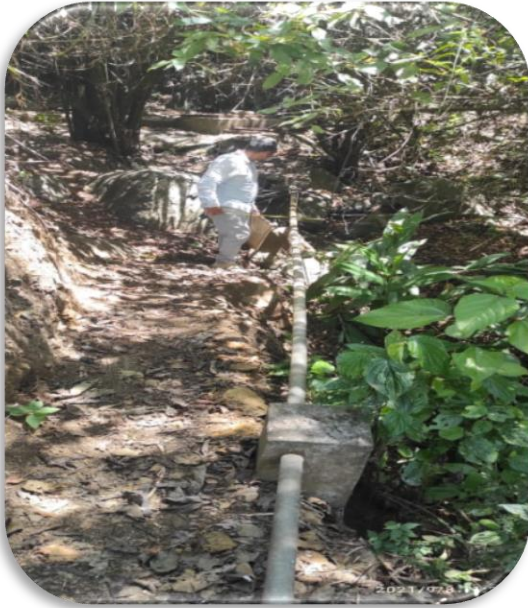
Tubería de 2” descubierta con dirección al Caserío el papayo.
